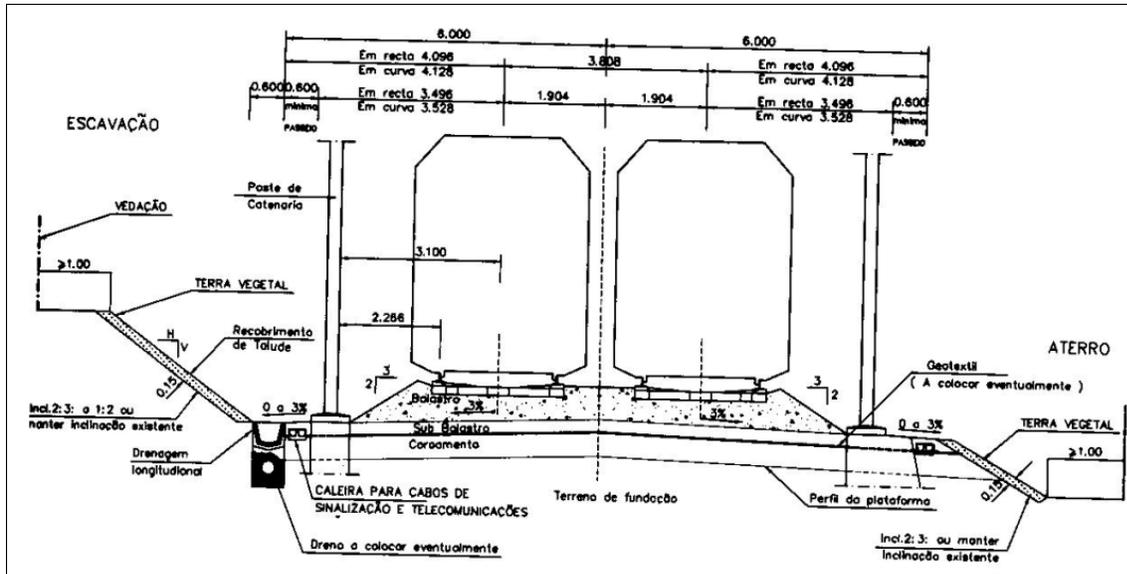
Corte transversal tipo de uma via férrea em alinhamento recto [Adaptado de 34]
